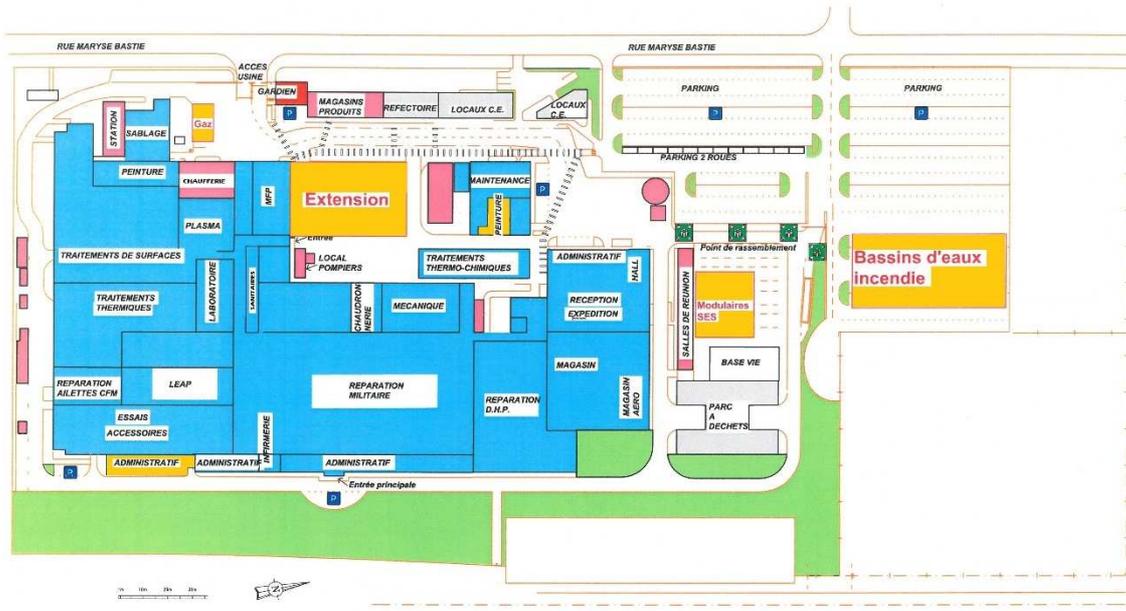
Plan de masse du site avec le projet de nouvel atelier (source Safran)
